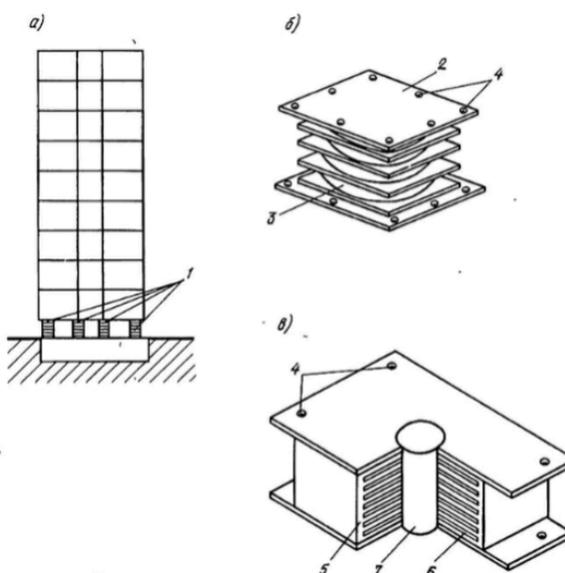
Сейсмоизоляция здания с помощью резинометаллических опор: (а) Схема установки опоры; (б) Схема конструкции опоры GAPEC; (в) Схема конструкции опоры, разработанной в Новой Зеландии; 1 – опоры; 2 – стальная плита; 3 – слой неопрена; 4 – отверстия для анкерных болтов; 5 – резина; 6 – сталь; 7 – свинец
